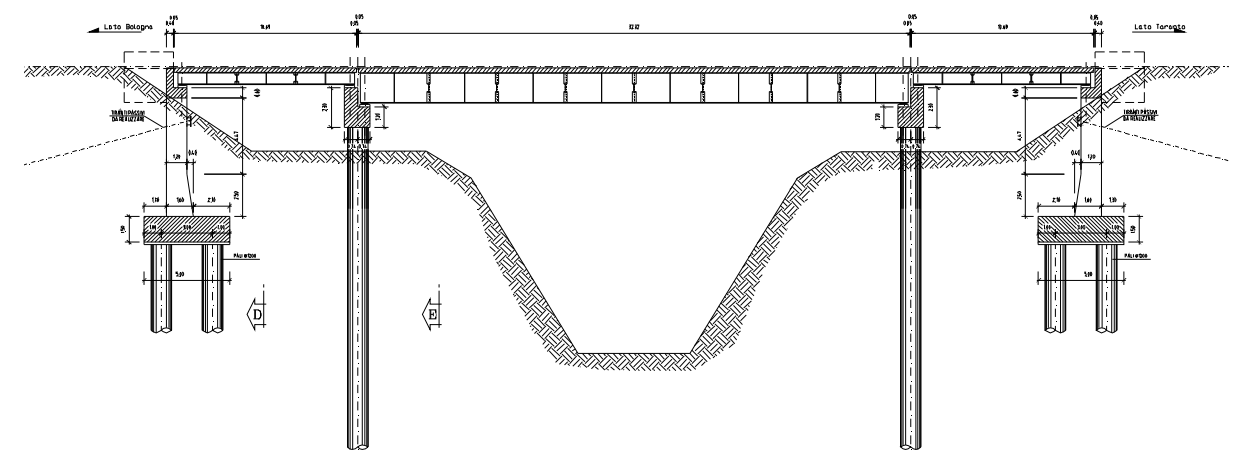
Ponte sul Torrente Santerno – Sezione longitudinale su struttura ampliata
